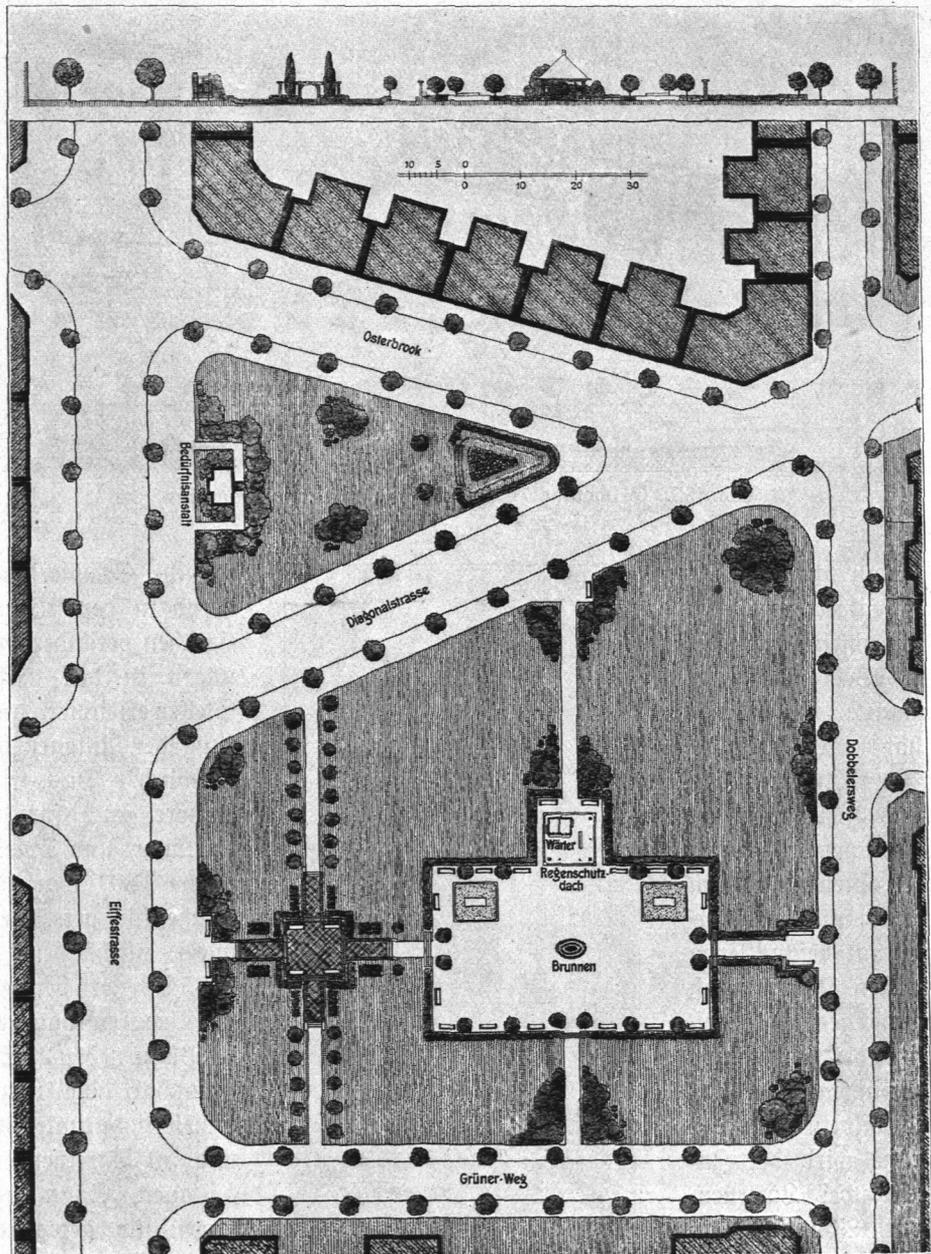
Grünanlage Eiffelstraße, Lageplan.
